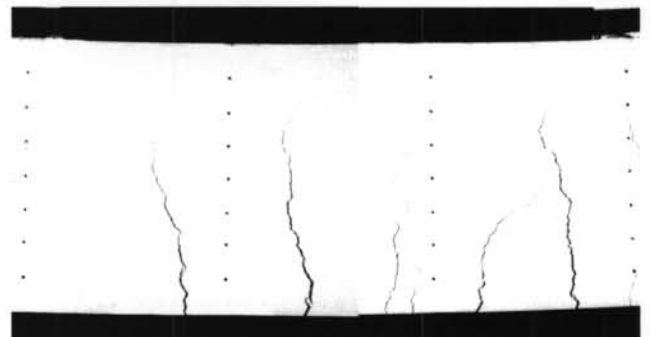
ひび割れ状況 (M1-Step 8)
